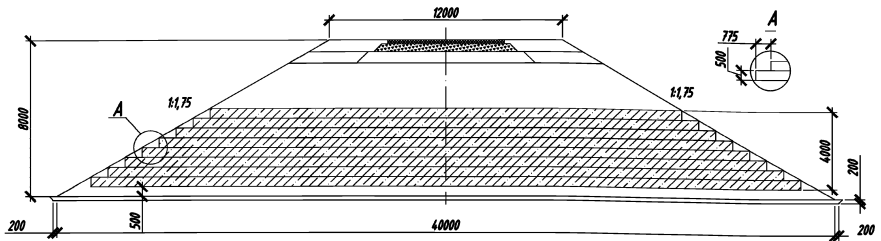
Конструкция легкой насыпи на расчетном поперечнике с учетом конечной осадки
